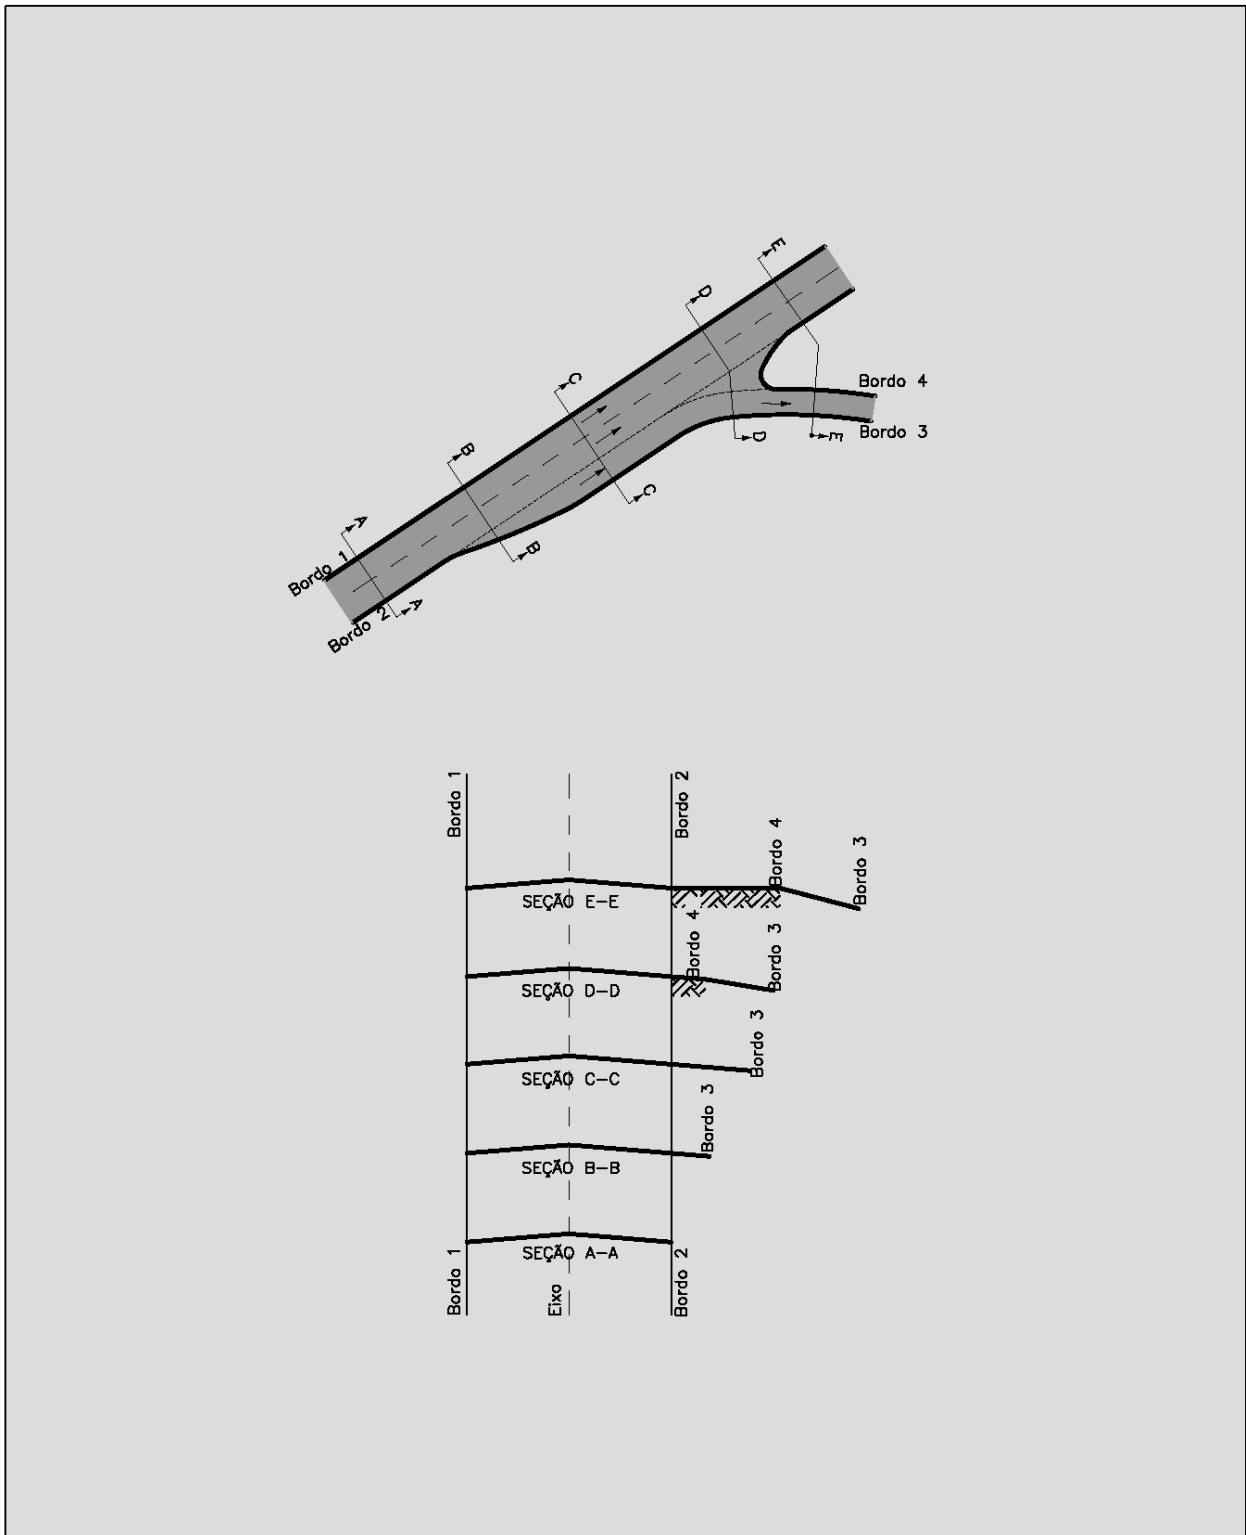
Desenvolvimento da superelevação nos terminais de conversão (Projeto com faixa de desaceleração do tipo paralelo)
